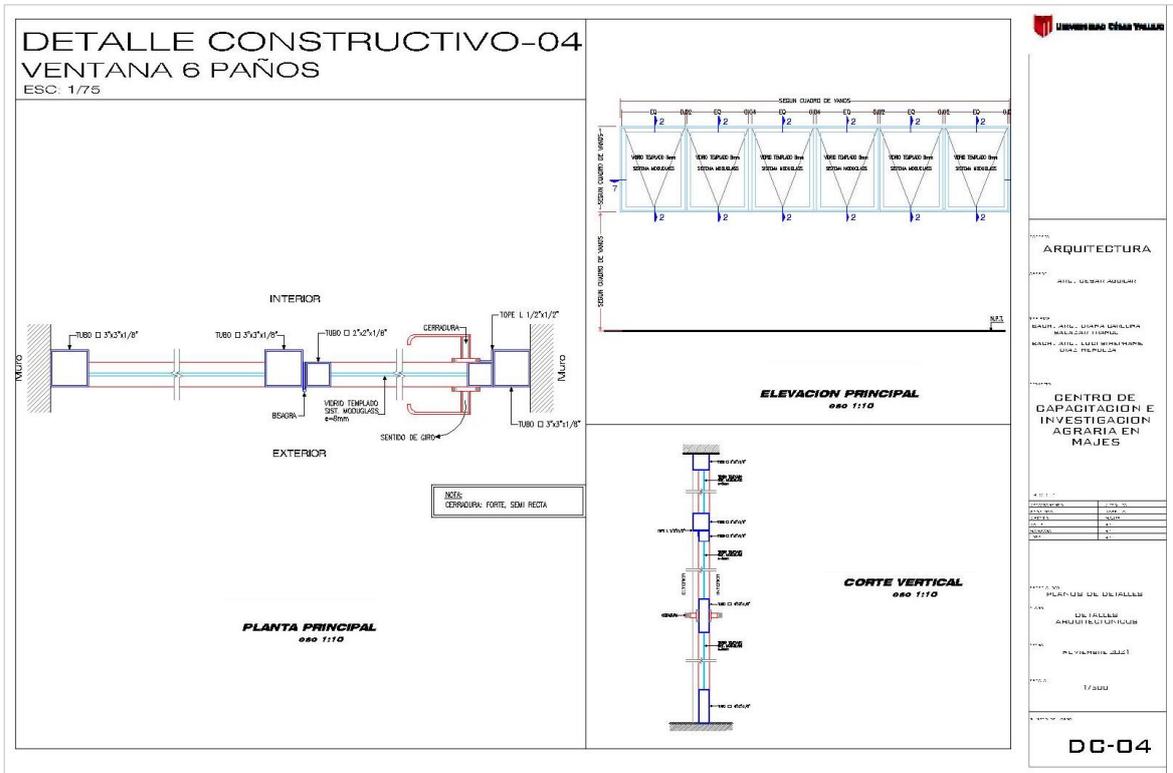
Plano de Detalle Constructivo ventana de 6 paños
